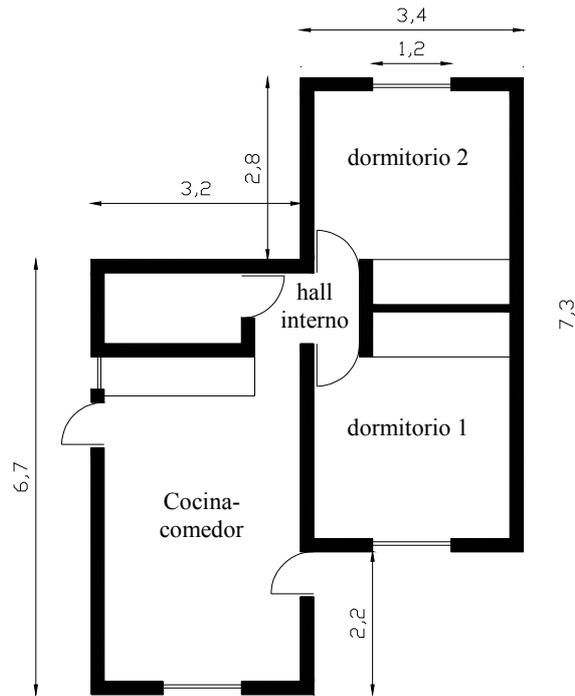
Planta vivienda B° 12 de octubre, tipología FONAVI
